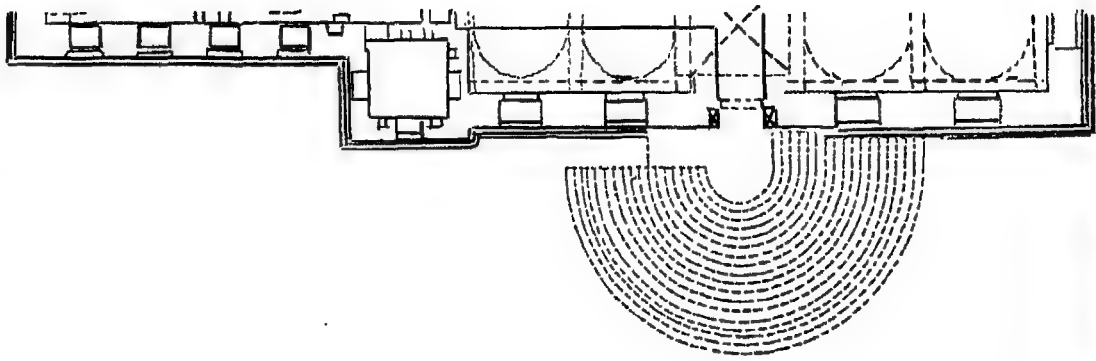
مسقط أفقى لجامع الملكة صفية.
